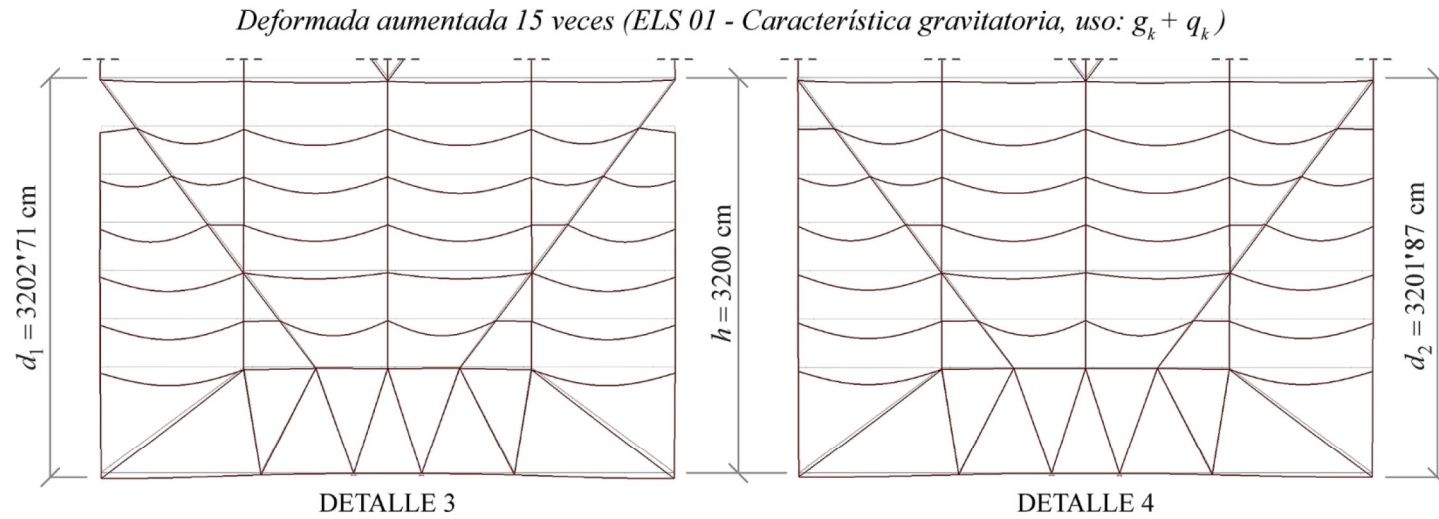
Deformadas de la transición estructural del alzado representativo con (detalle 3) y sin (detalle 4) interrupción de pilares laterales. Se observa un descenso mayor de los nudos perimetrales en el modelo con interrupción de pilares.
